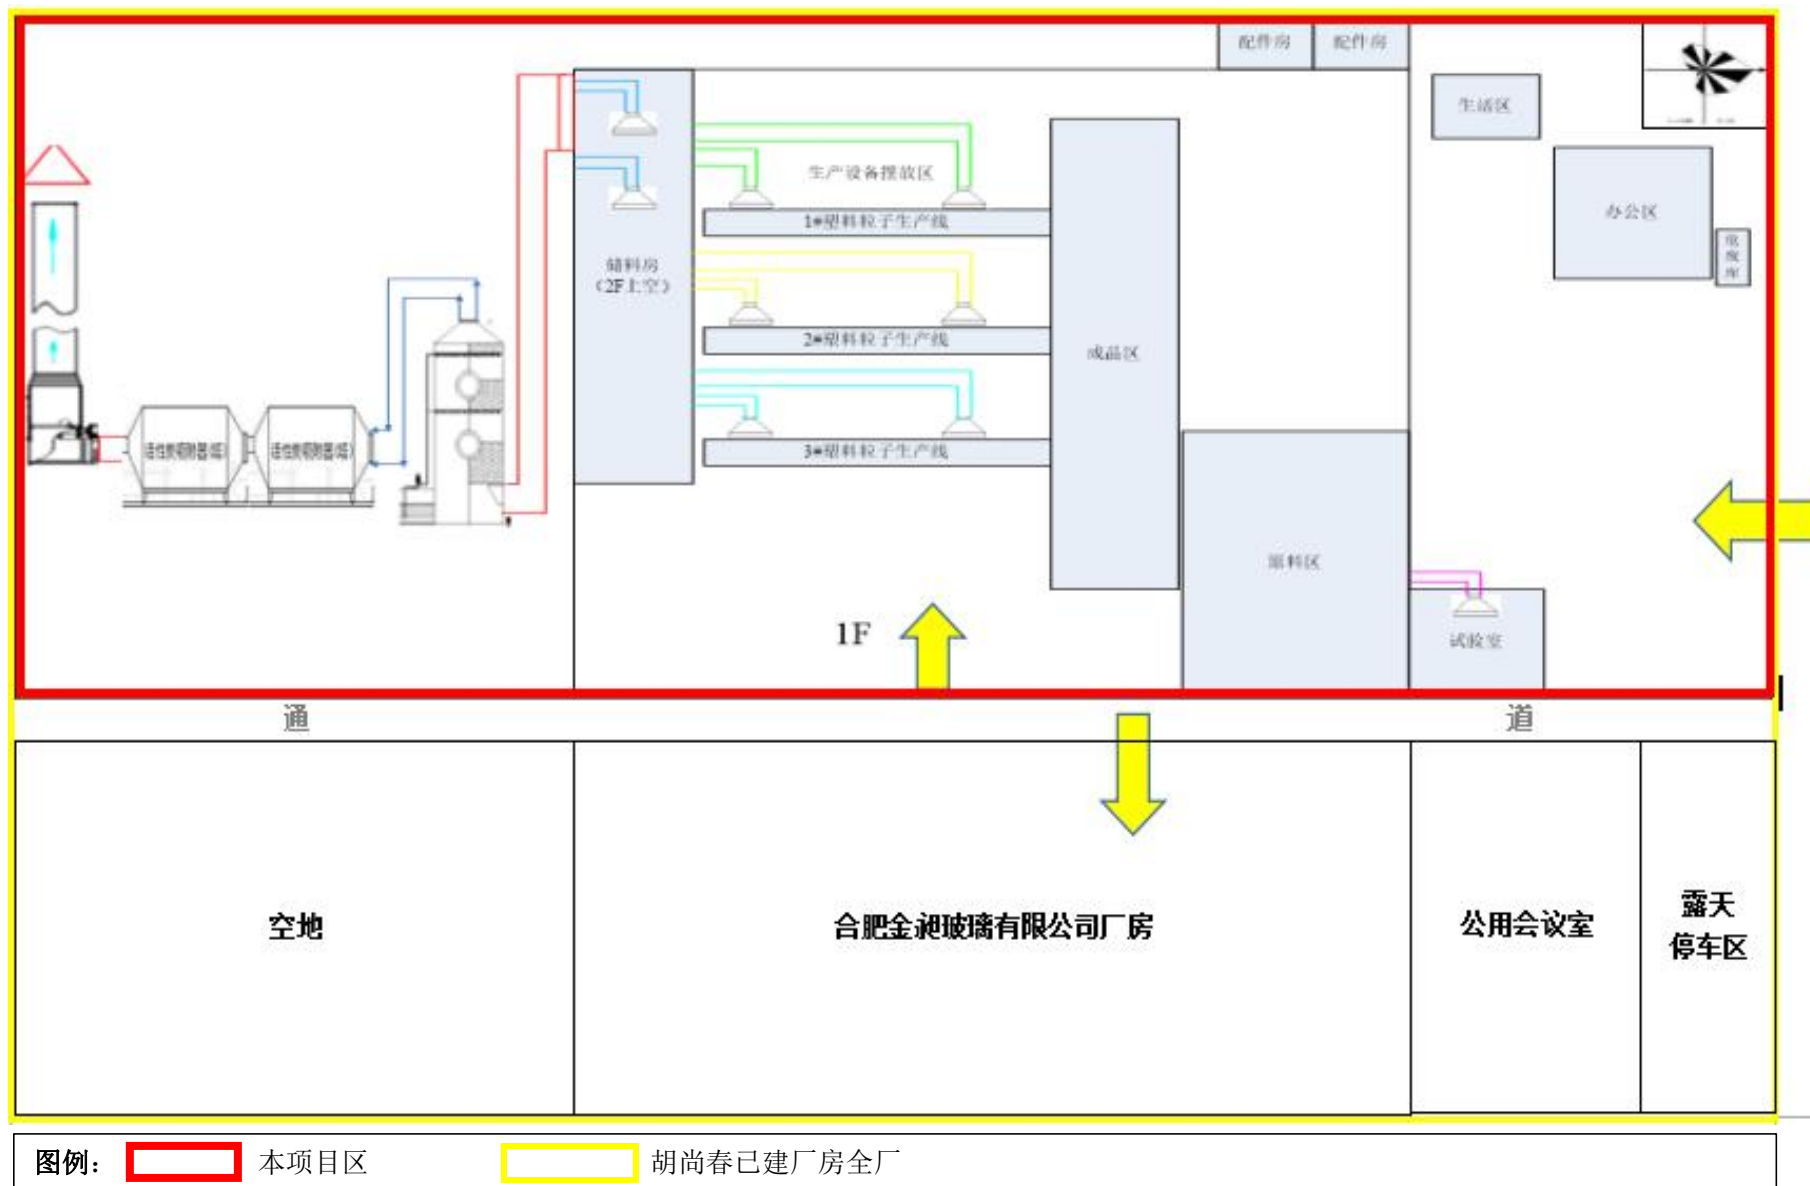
胡尚春已建厂房全厂总平面布置图
